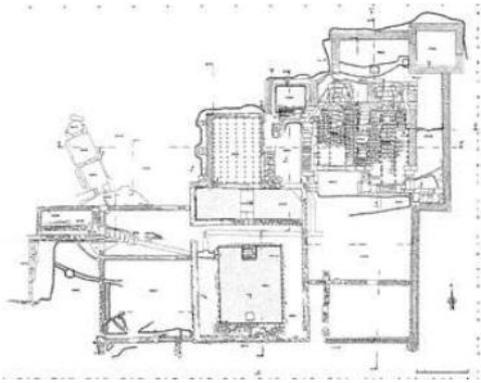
e 34: Planta e corte de estruturas das termas de Tongóbrica – Marco de Canavezes
